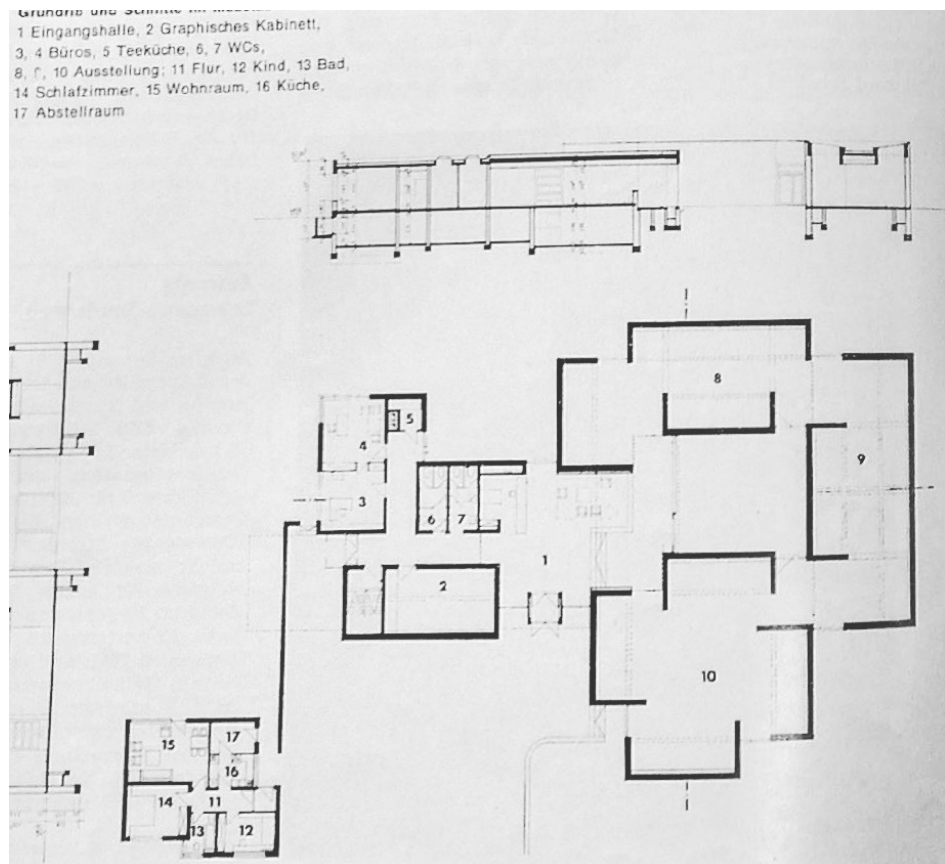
Grundriss EG, ursprüngliches Raumprogramm mit ursprünglichen Raumnummern
